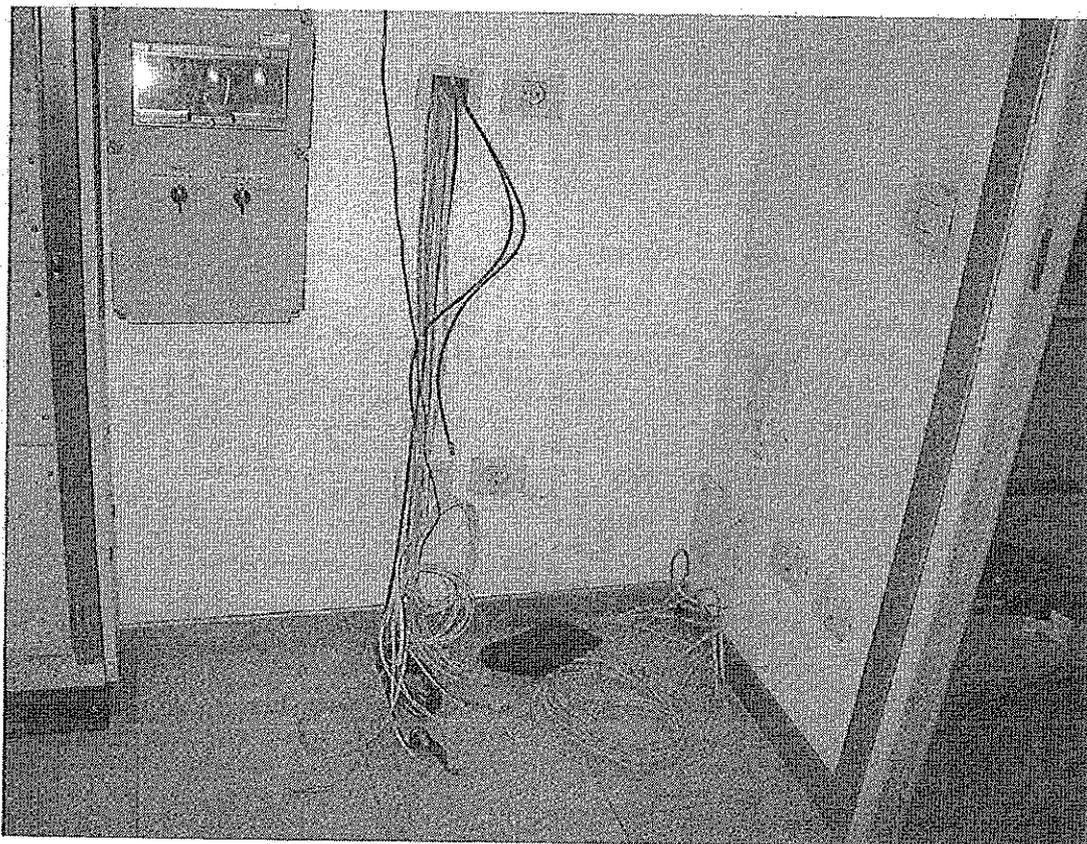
Stato di fatto dei collegamenti elettrici nel negozio ex [REDACTED]
